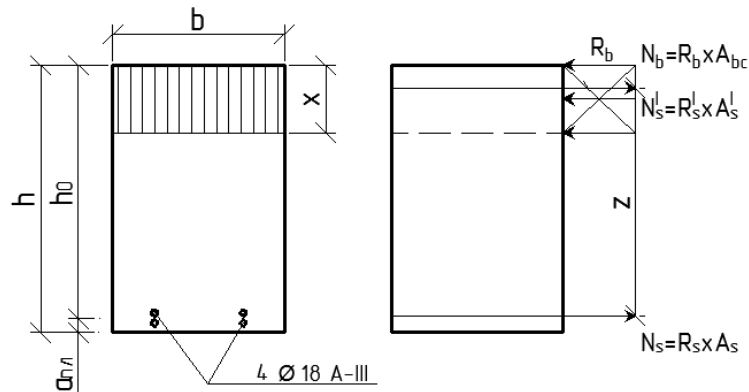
Схема внутренних усилий ригеля в первом пролёте
